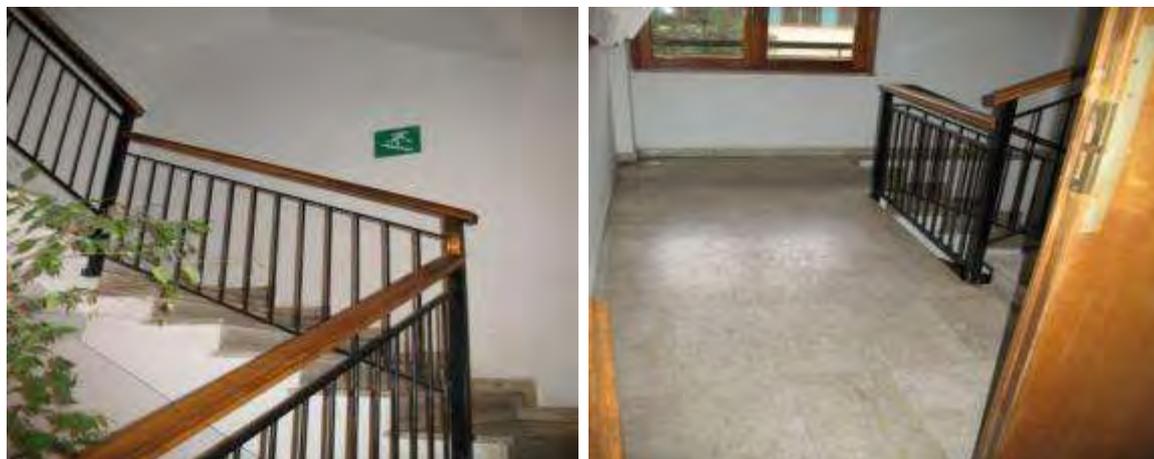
, 9–Vano scala e pianerottolo di riposo.
